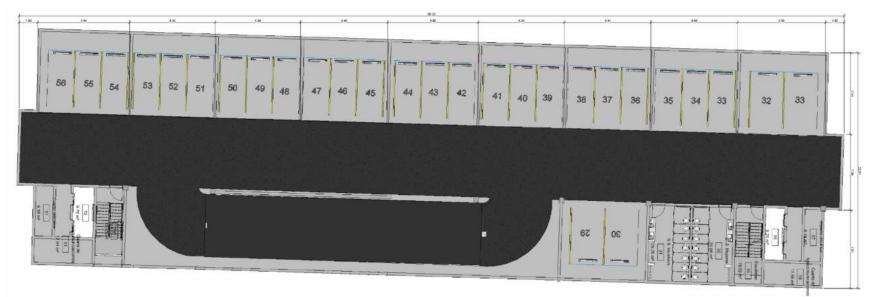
Planta segundo nivel subterráneo para propuesta arquitectónica de parqueo subterráneo.
